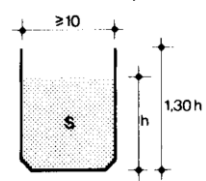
Sección del canalón (extracto de la NTE QTS)
